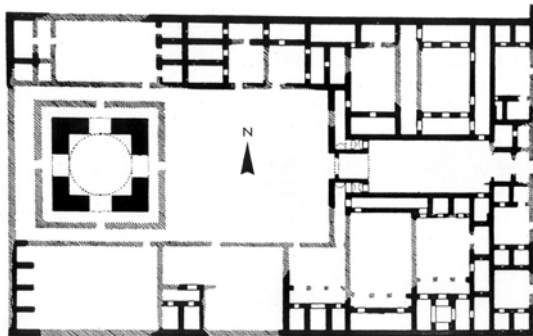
Grundriss Čahār Qāpū/Qaṣr-i Šīrīn
